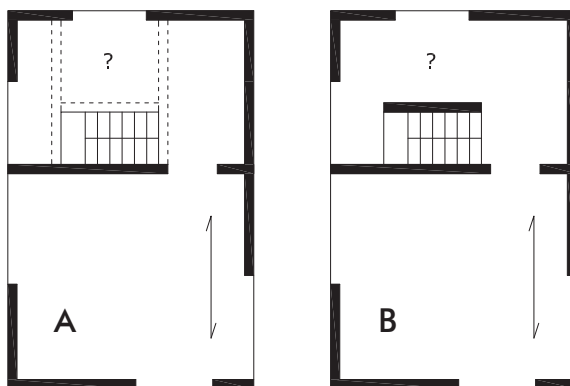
Disposizione in pianta dei solai. L'apertura del vano scale deve essere rinforzata con travi (tratteggiate) come in A, oppure deve essere presente un muro per appoggiare il solaio come in B.
